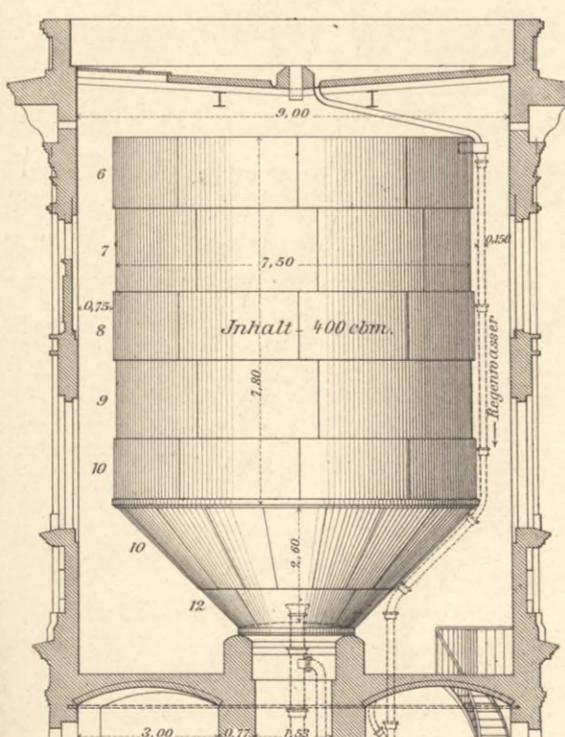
Wasserturm für Szegedin. M. 1:300.
